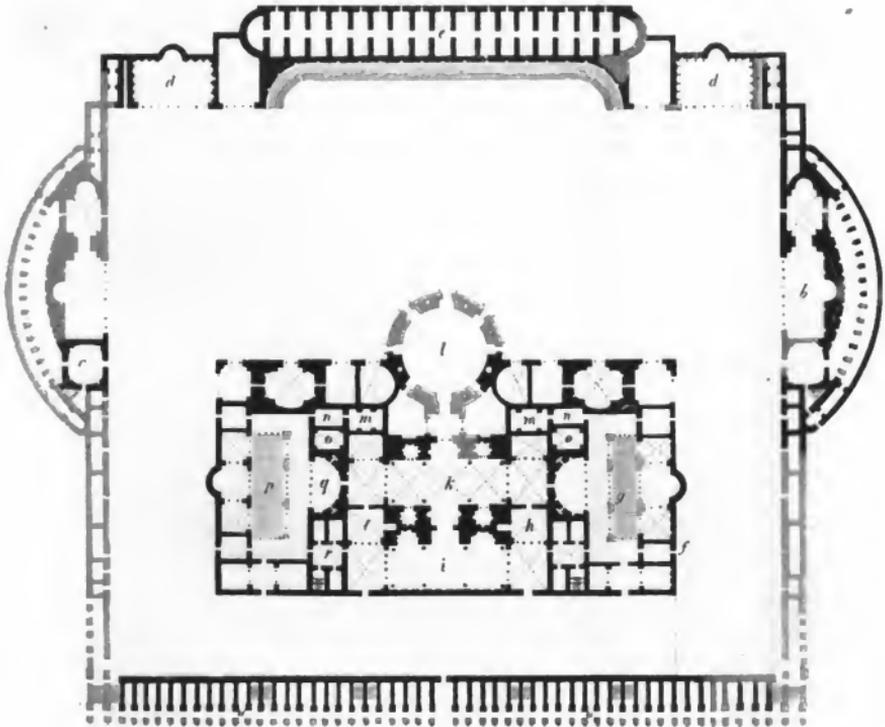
Grundriss der Thermen des Caracalla.
